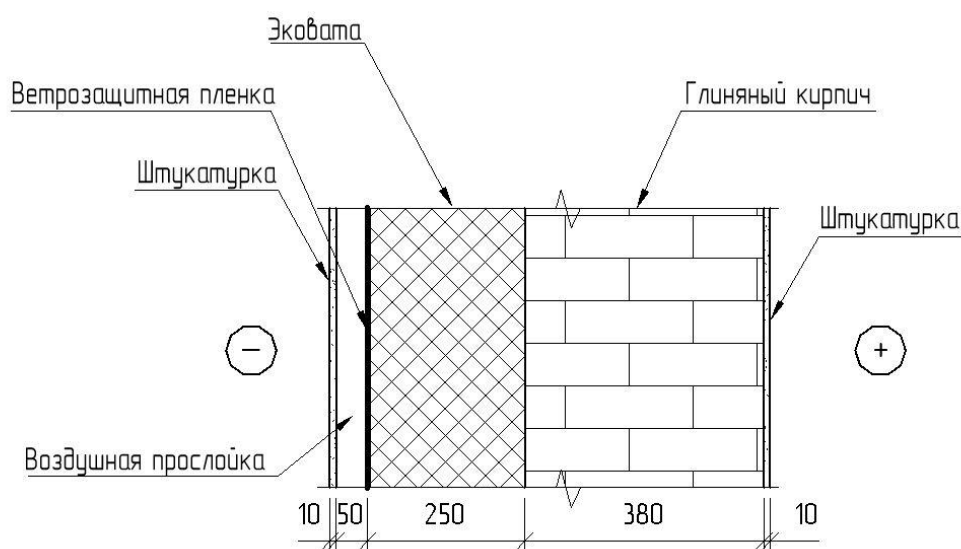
Эскиз фрагмента наружной стены с применением утеплителя Эквата
